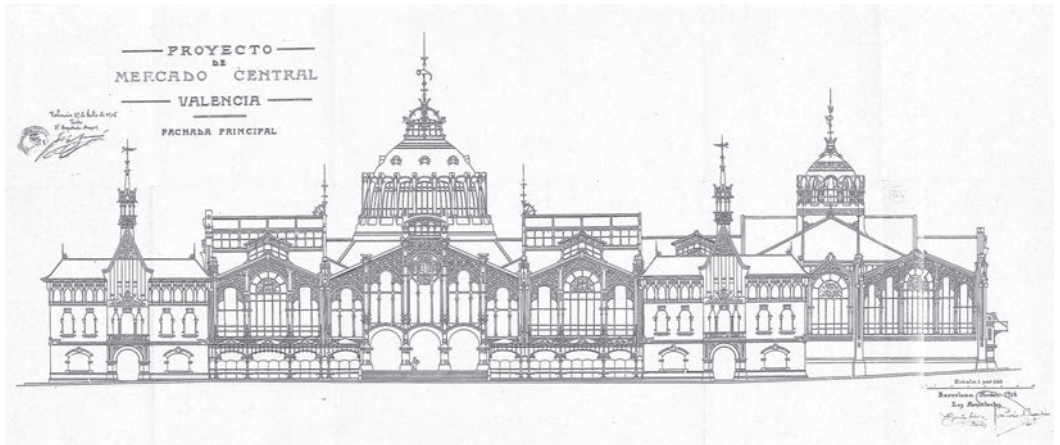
Fachada Principal proyectada 1914 por Alejandro Soler i March y Francisco Guardia i Vial. Archivo servicio de arquitectura del Mercado Central de Valencia
